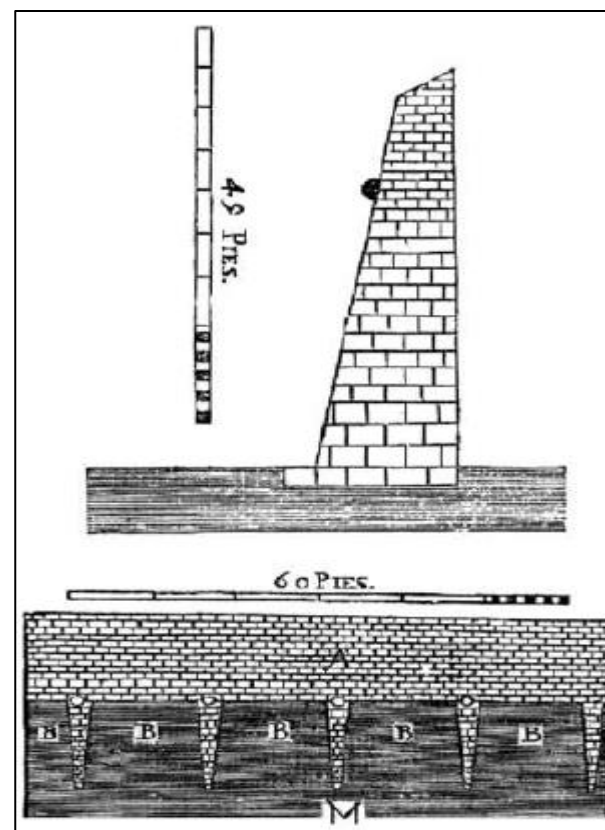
sección de camisa amurallada y planta del contrafuerte. Examen de fortificación. Diego Gonzalez Medina Barba.1599
